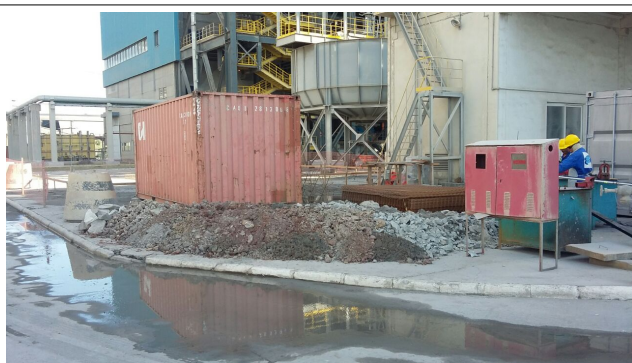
Instalação das caldeiras auxiliares da Fase C.
